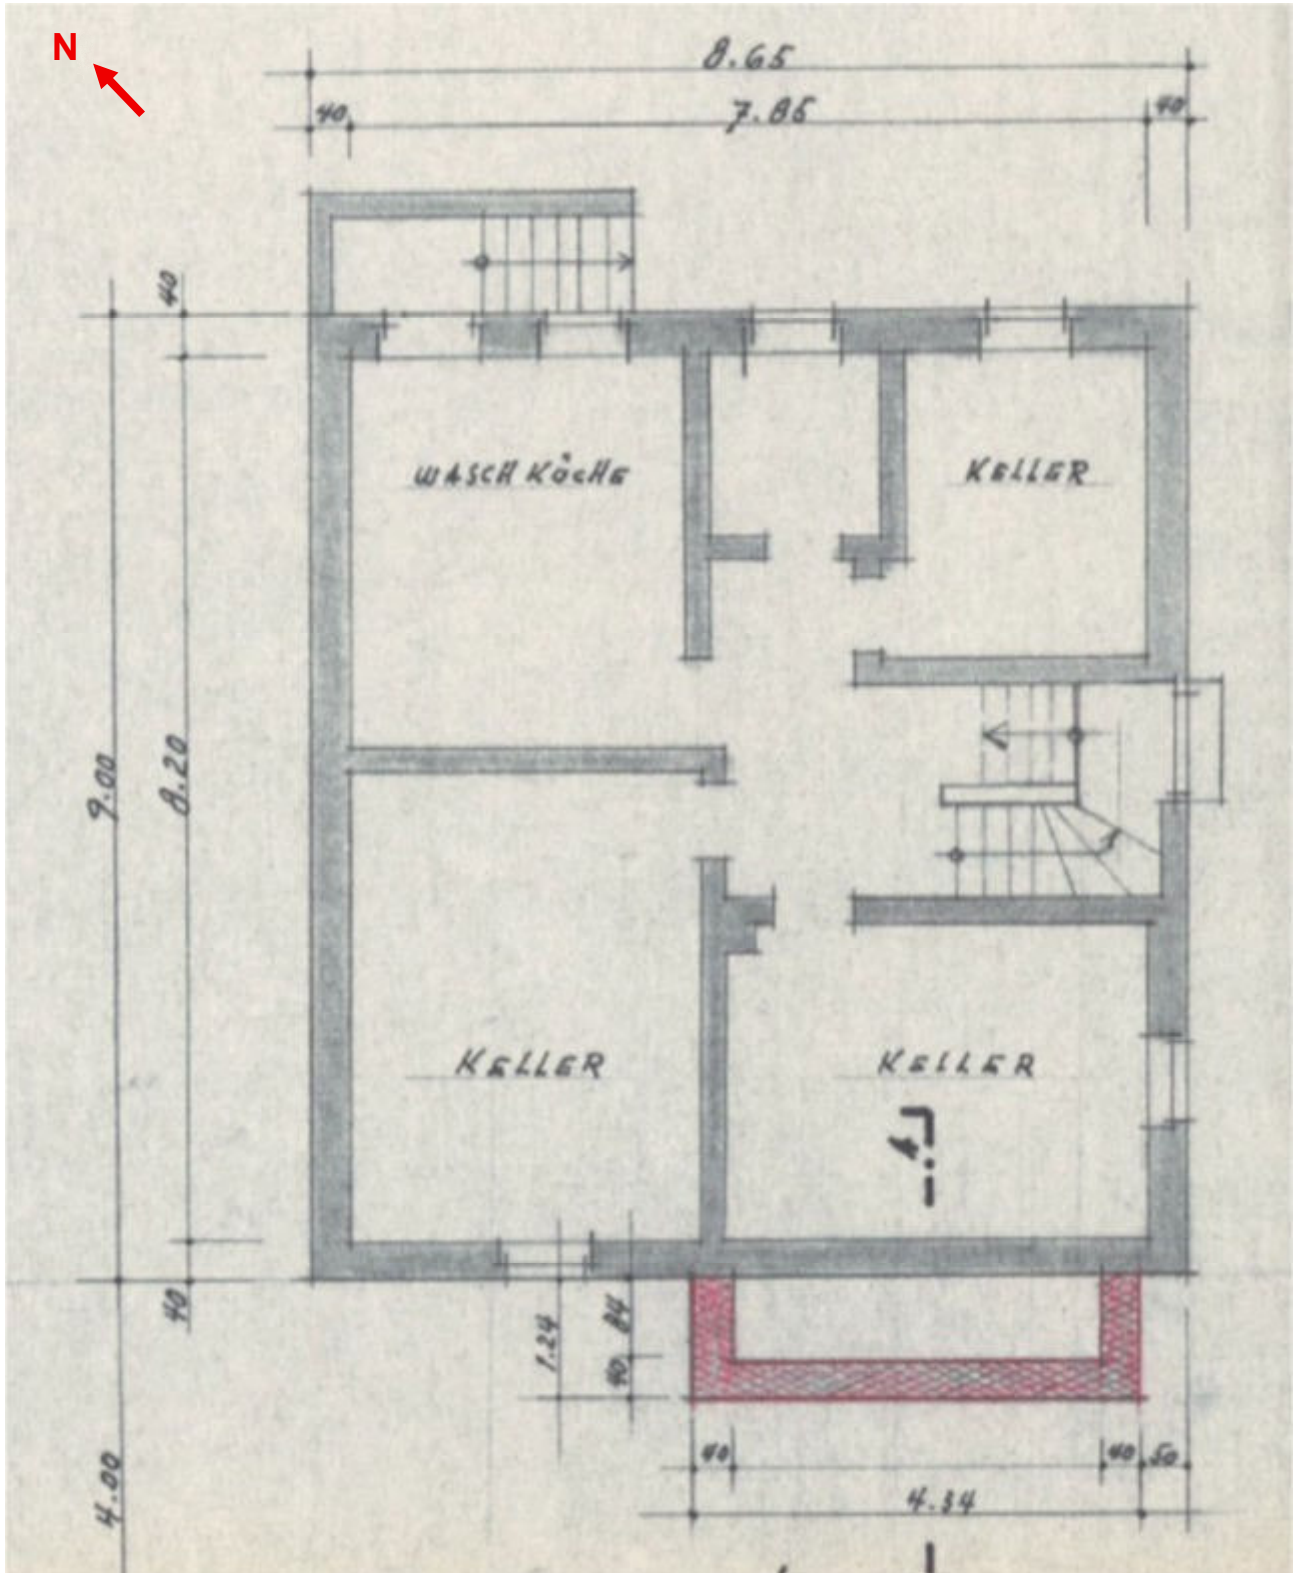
Grundriss Kellergeschoss (ohne Maßstab) 1965; Quelle: Bauakte Errichtung einer Garage und eines Erkers; Nordpfeil d.d. SV
